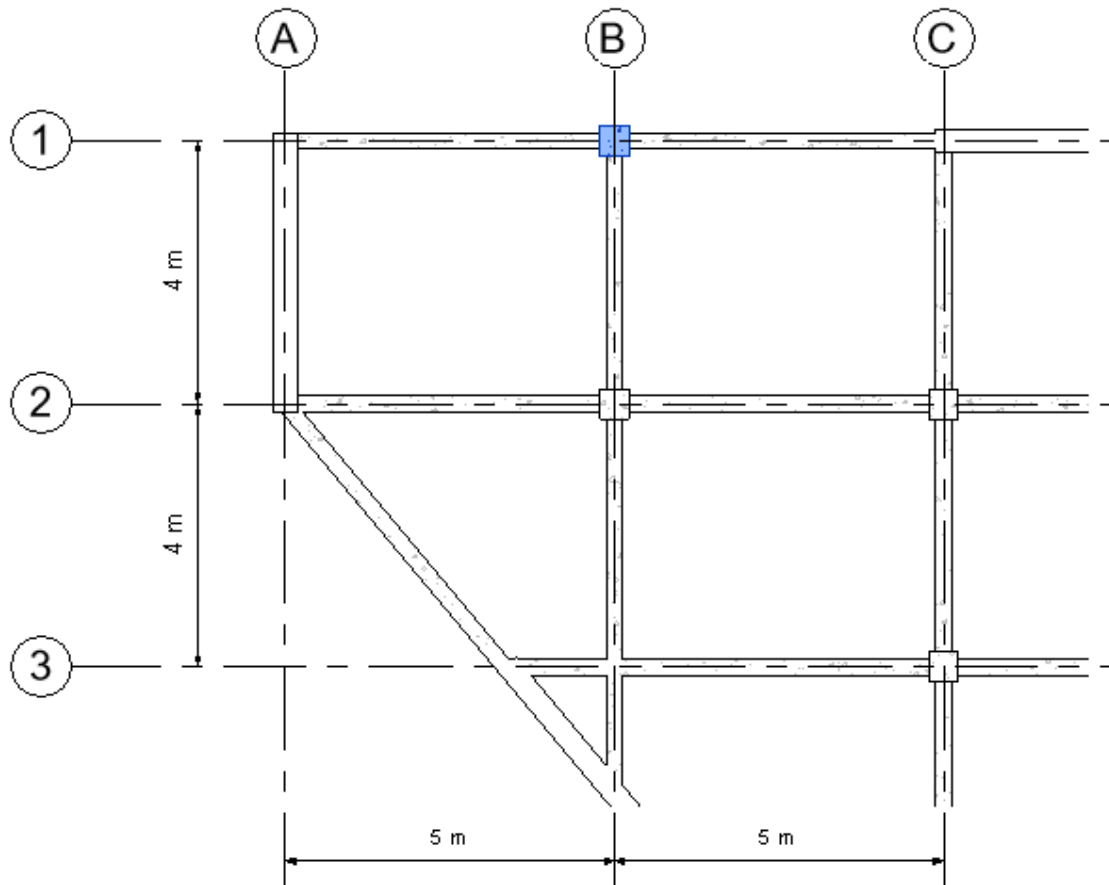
Columna de diseño. Fuente: elaboración propia.
